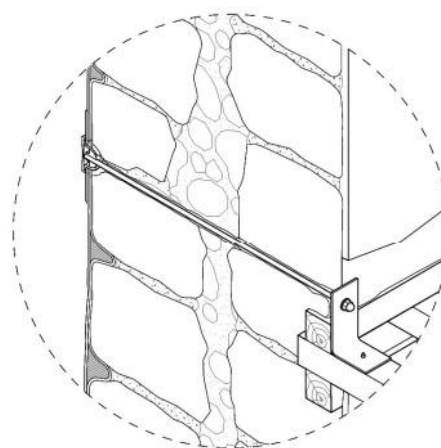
Esquema de pormenor do reforço da ligação entre paredes e pavimentos com recurso a peças metálicas [Cóias, 2007]
